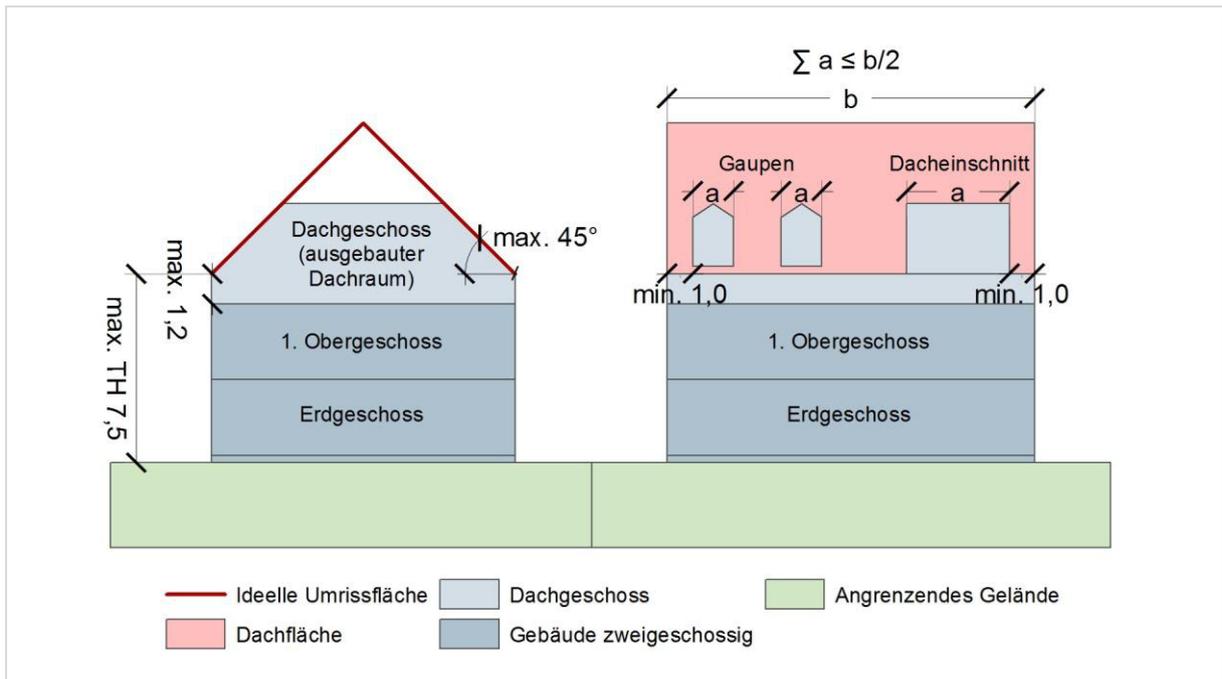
Schemaskizze Festlegung Dachgeschoss, TOPOS III
